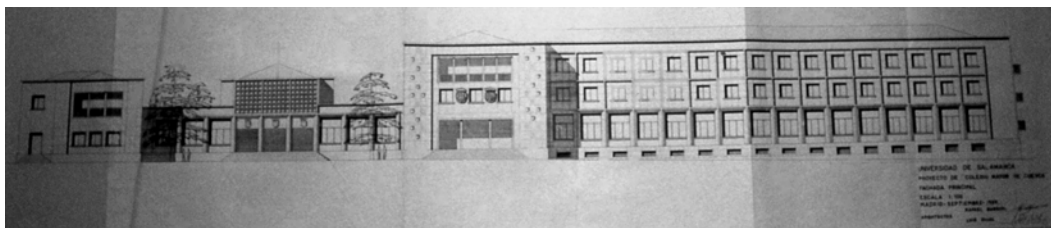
Proyecto de Colegio Mayor Cuenca: bosquejo de fachada principal.
